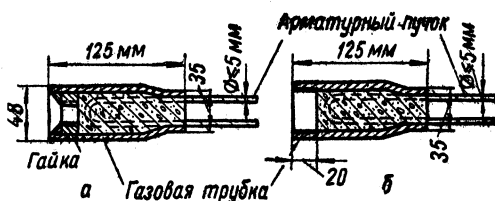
Анкеровка пары или нескольких пар проволок из твердых сталей при помощи газовой трубки:
